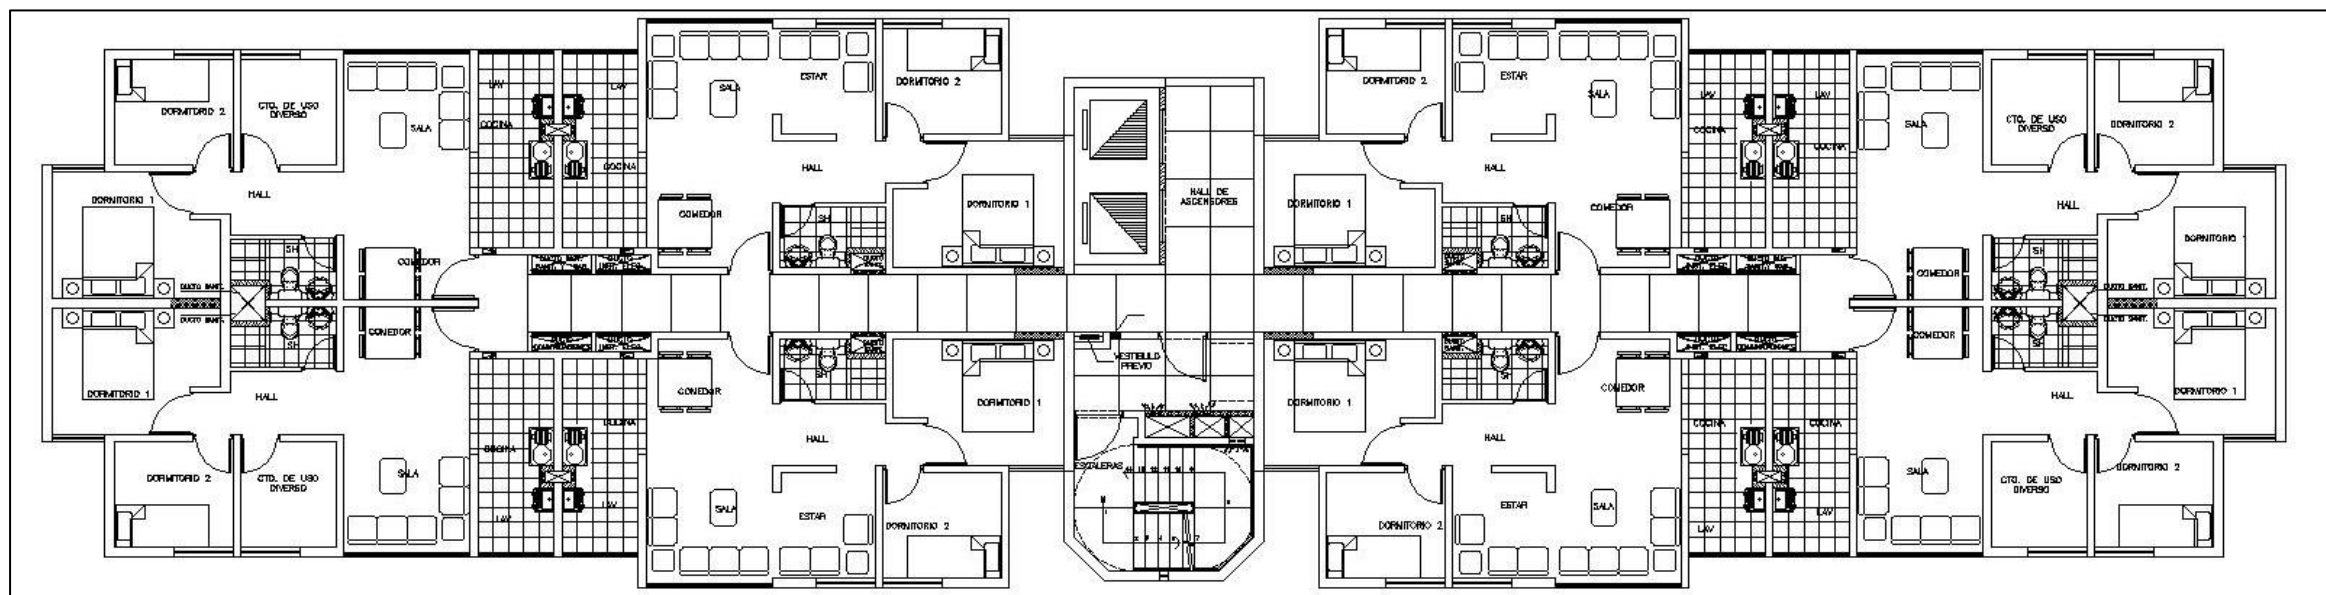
Arquitectura de Planta típica. Fuente: proyecto 02
